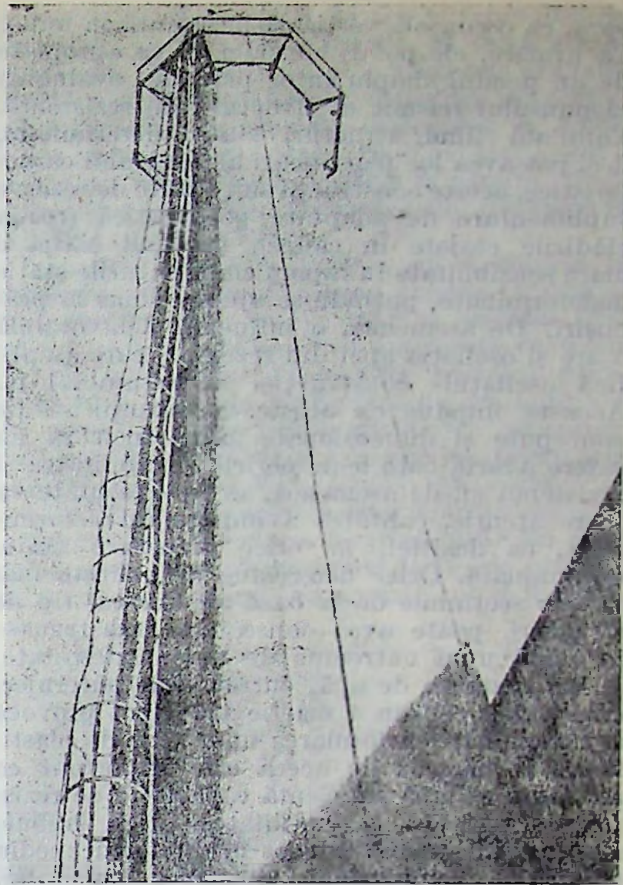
Coș de fum din beton armat, fisura la cutremur (Întrep. de cinescoape — București).
